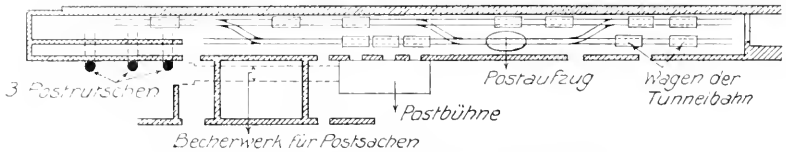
Grundriß eines Teils der Gleisanlagen unter dem Bürgersteig.
